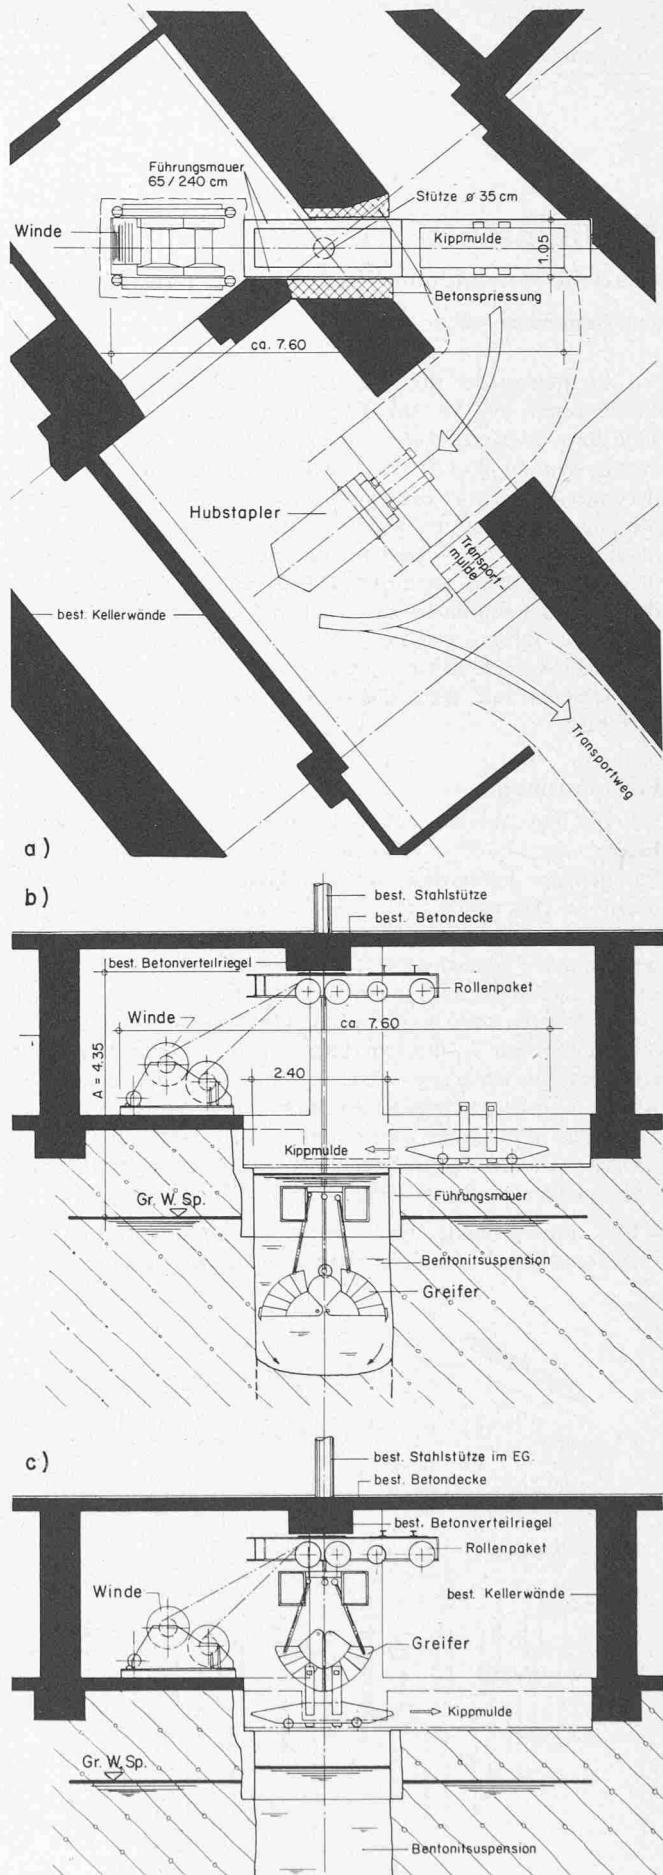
Grundinstallationen für den Aushub. a) Ausschnitt Kellergrundriss b) Aushub (Greifer) c) Entleeren
